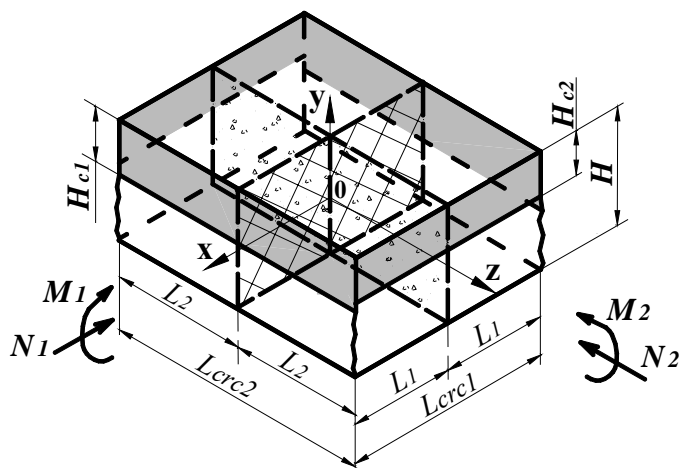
Расчетная схема железобетонного элемента с пересекающимися трещинами при положительных направлениях усилий
